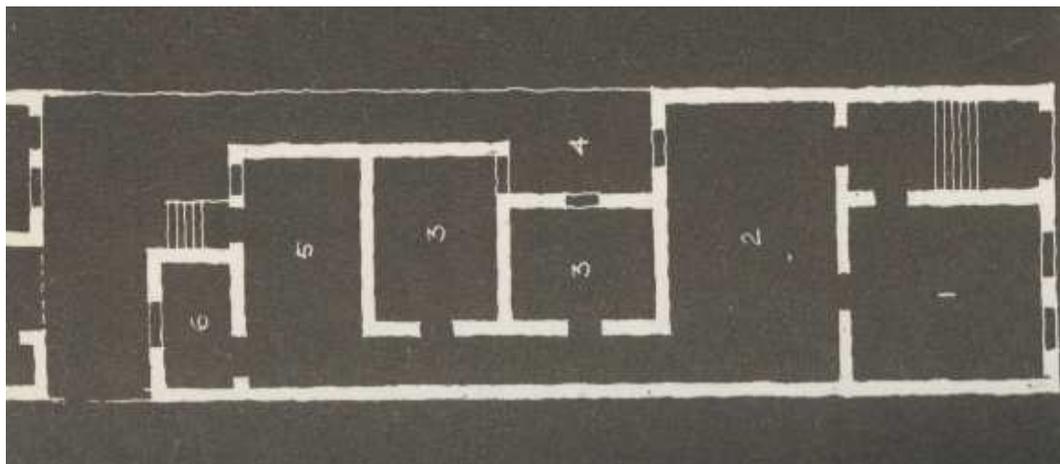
Planta – Baixa Residência com banheiro (Fonte: REIS FILHO)
